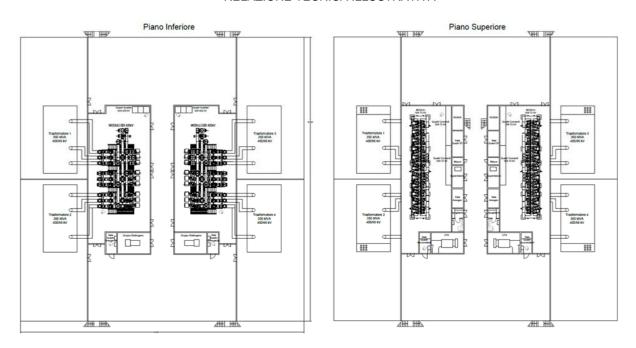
pianta elettromeccanica della Stazione Elettrica galleggiante
